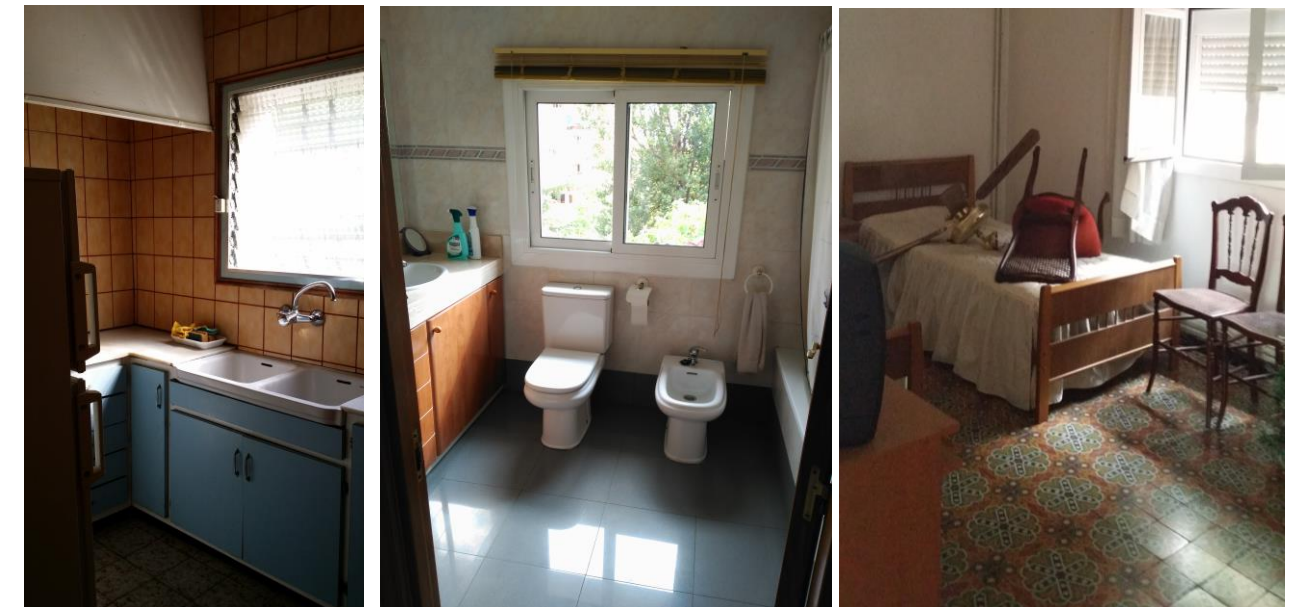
Cocina de planta baja, baño de planta primera y habitación
